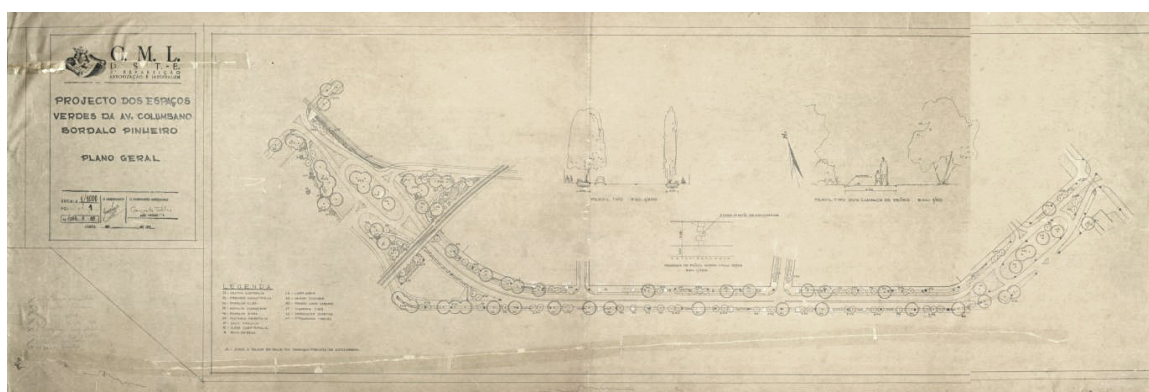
Projeto dos espaços verdes da Av. Columbano Bordalo Pinheiro. Planta Geral. Ribeiro Telles, sd.
